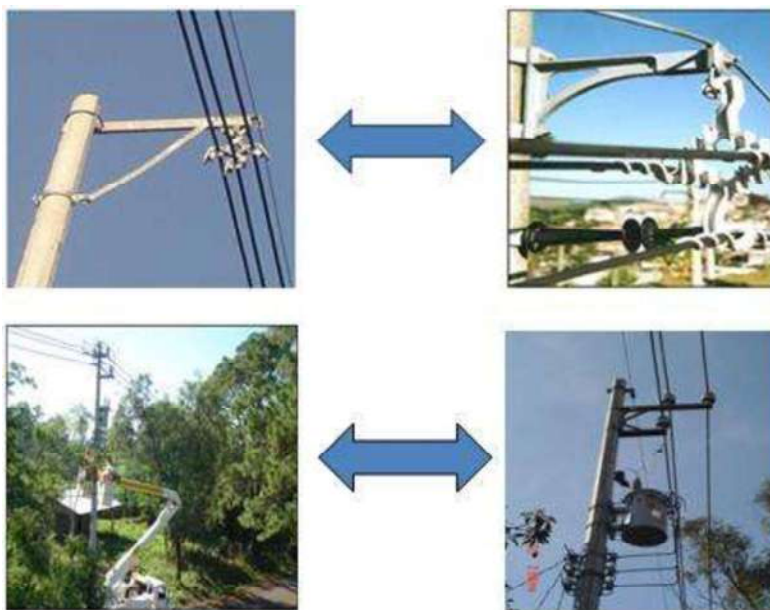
Comparación de red eléctrica compacta construida con herrajes modificados (figuras de la izquierda) y herrajes normalizados (figuras de la derecha).
